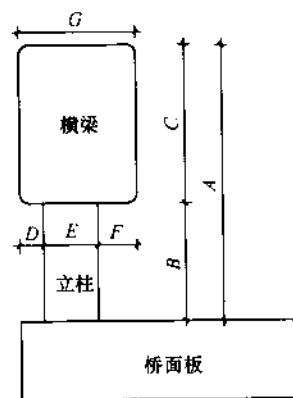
钢筋混凝土梁柱式护栏 (单位: cm)
